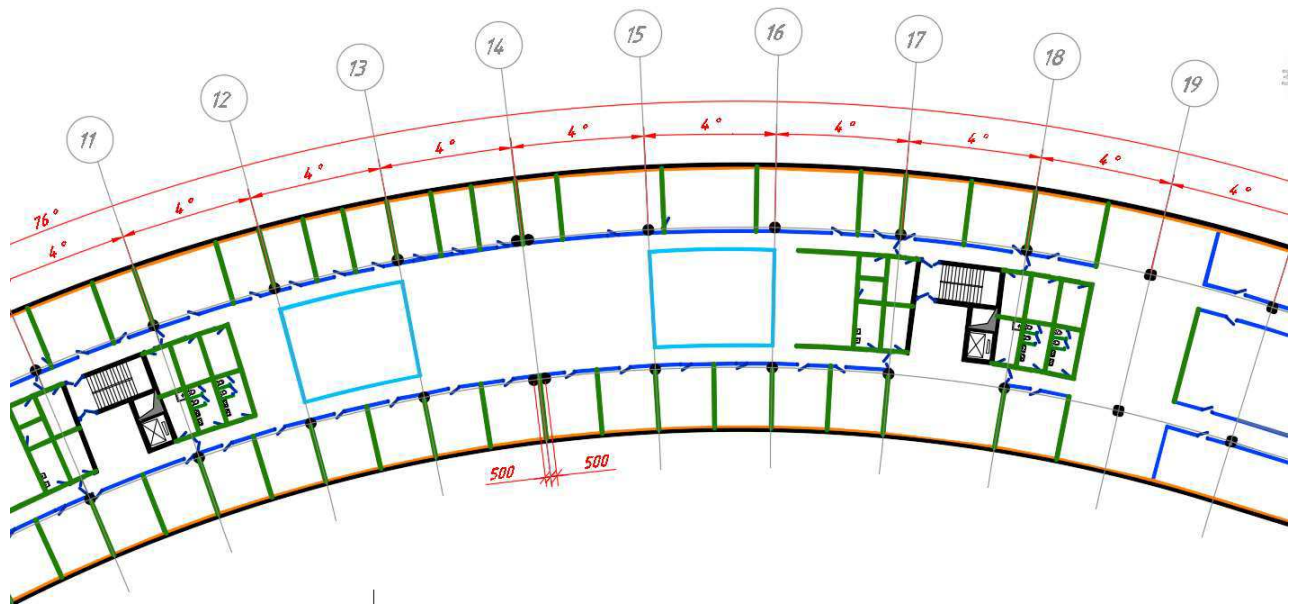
Фрагмент плана срединных линий конструкций (формирование подложки)
